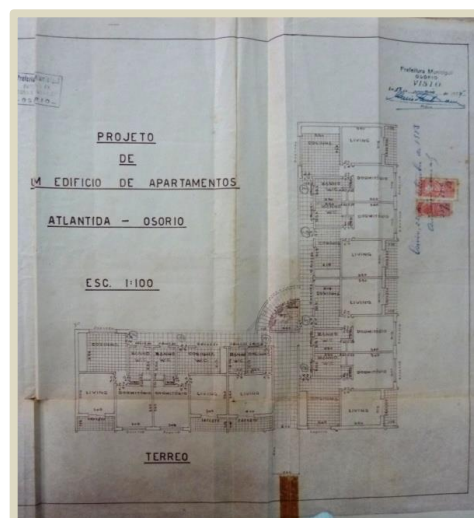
Planta do pavimento térreo da primeira etapa, em esquina, aprovado em 1955.
